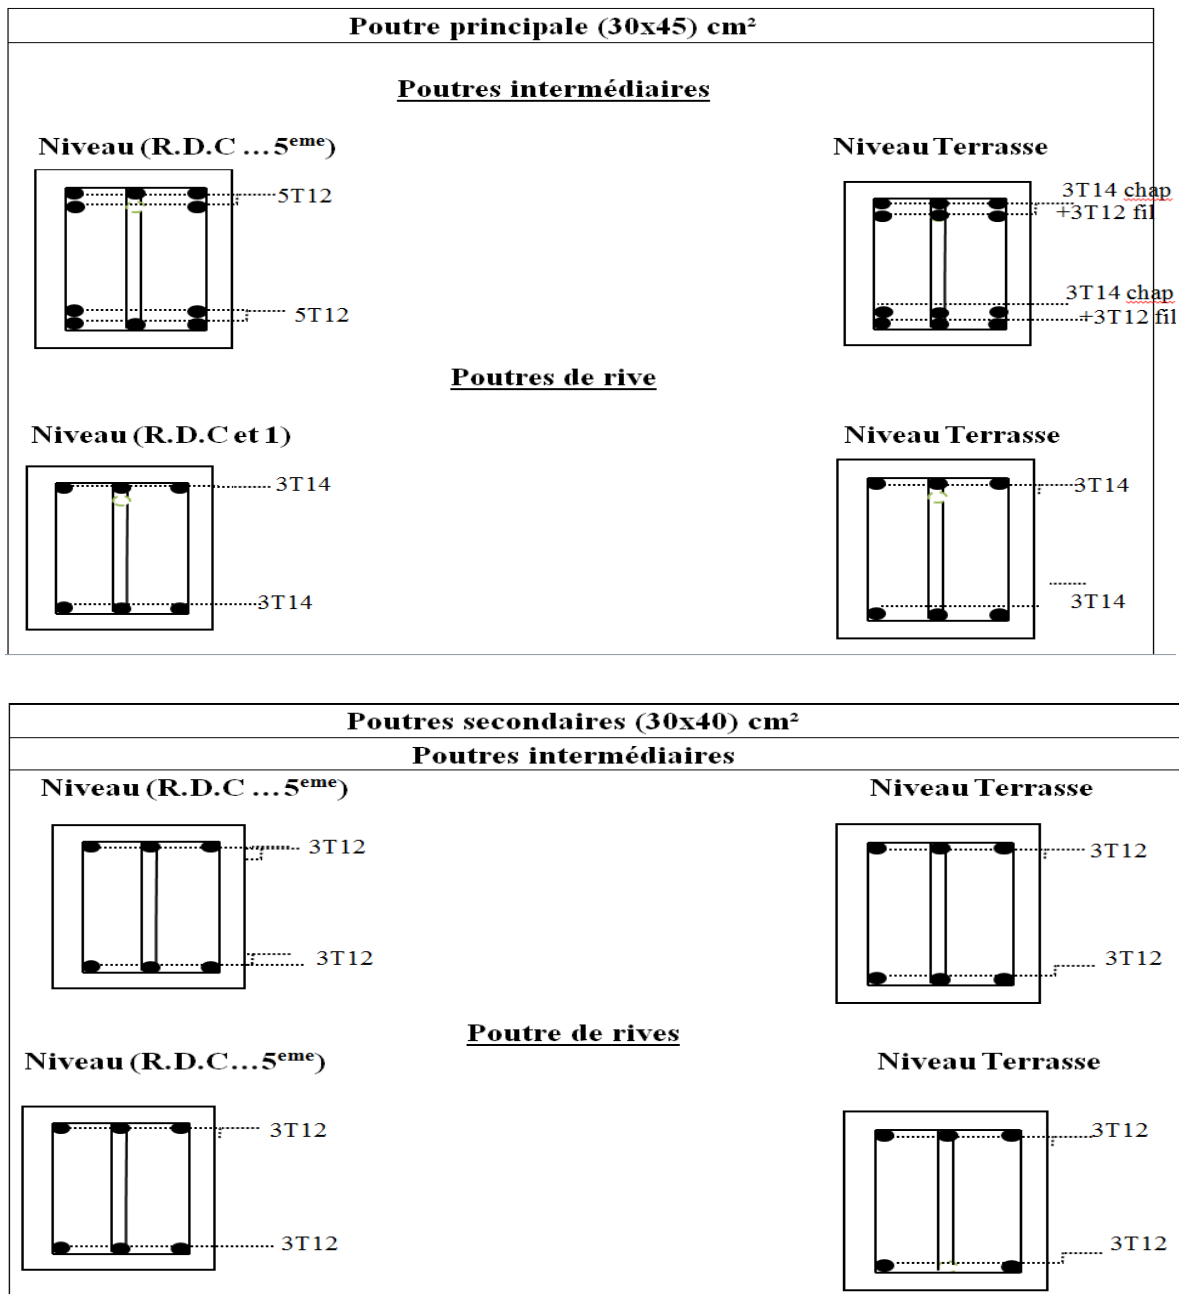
Dessin de ferraillage des sections des poutres principales et secondaires.
